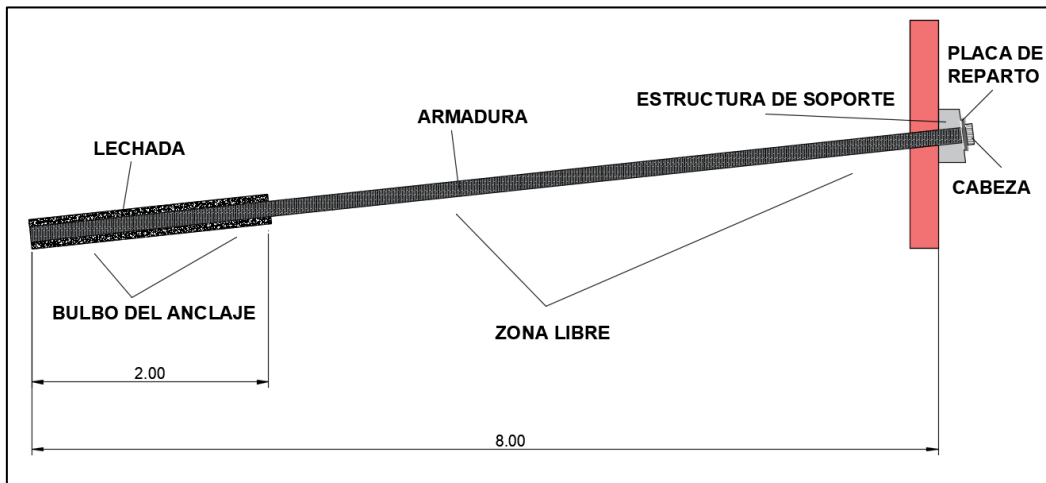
Esquema en detalle del anclaje pasivo con barras de 50 mm. Fuente: Propia
